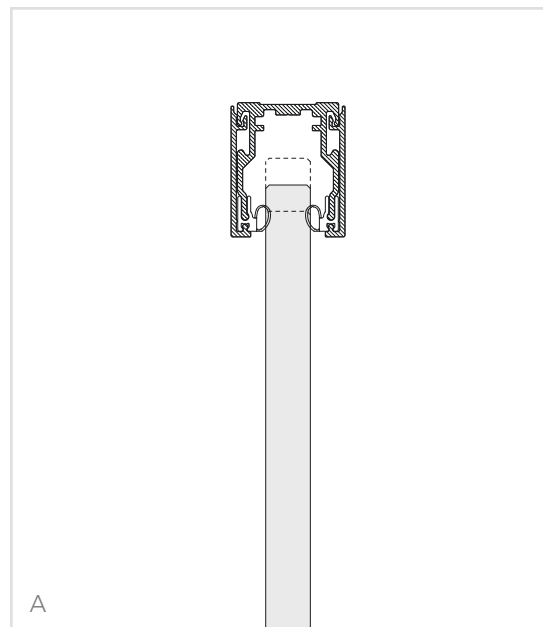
fig. A: Sezione tratta telescopica H 38 - sezione verticale
